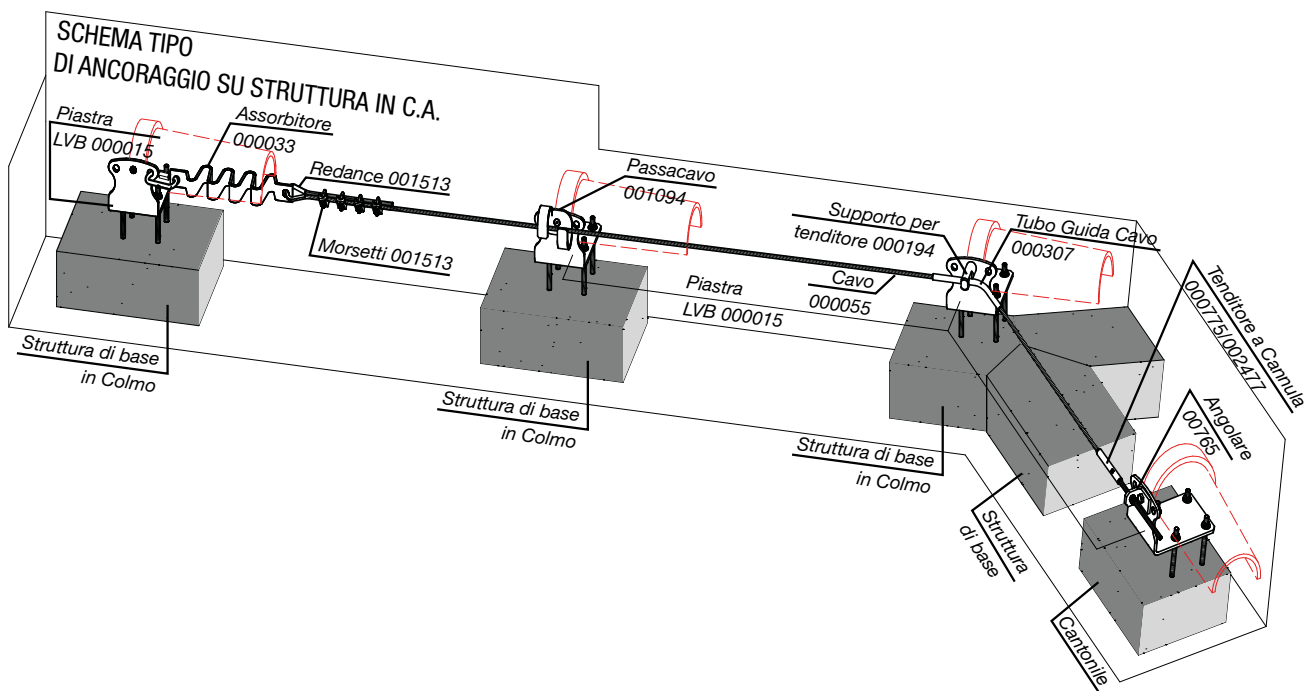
Linea vita LVB fissata su struttura di supporto in cemento.
